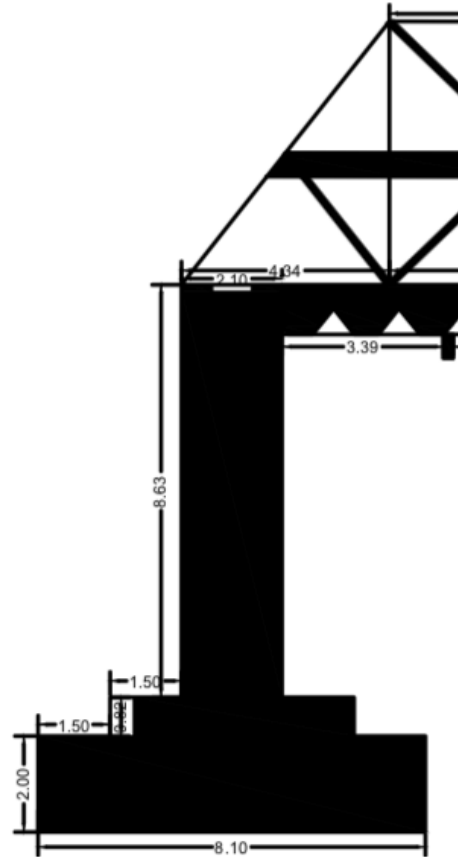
Alzado ubicación zapata y pilote. Fuente propia
